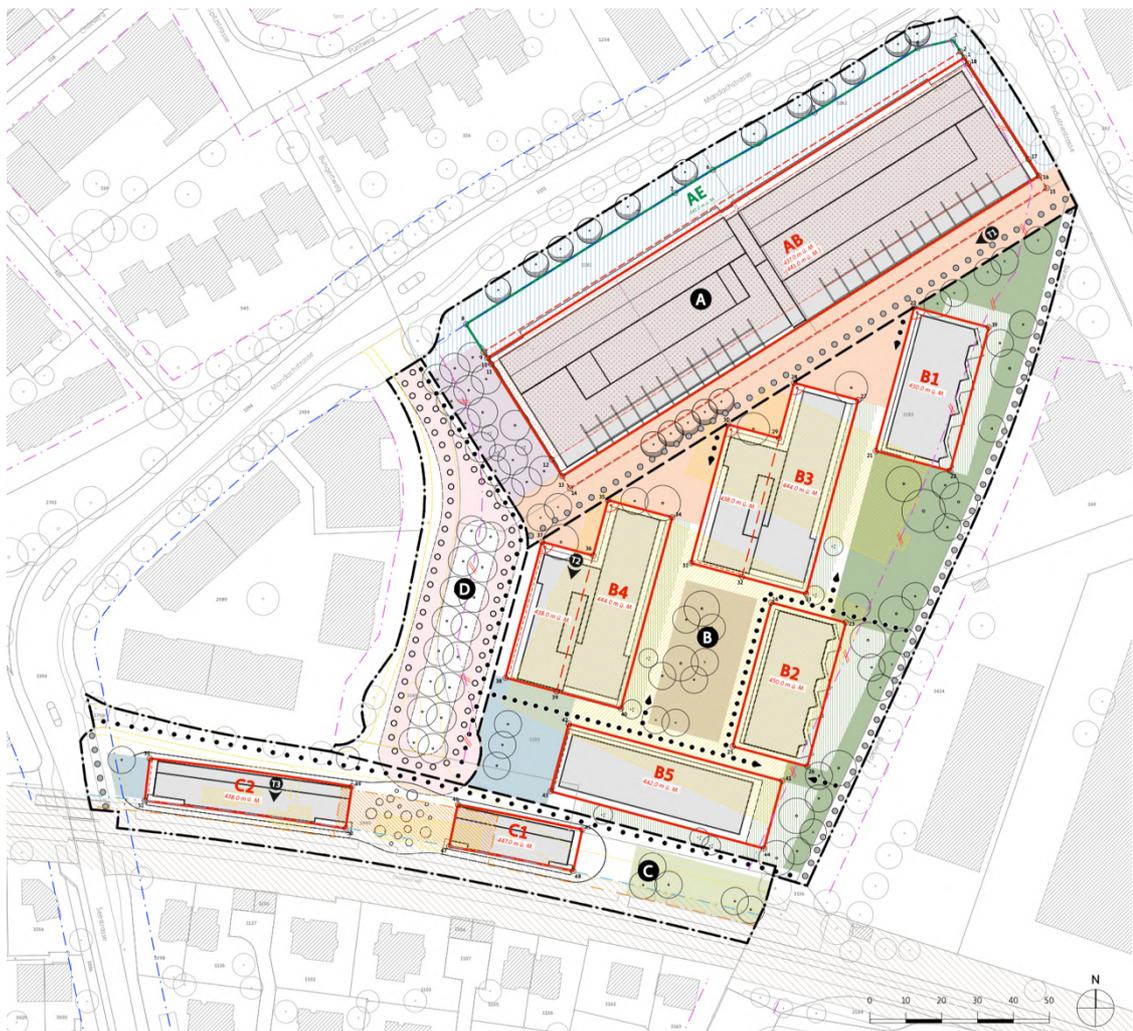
Privater Gestaltungsplan «Im Farn», Situationsplan, Planwerkstadt, 19.01.2024
